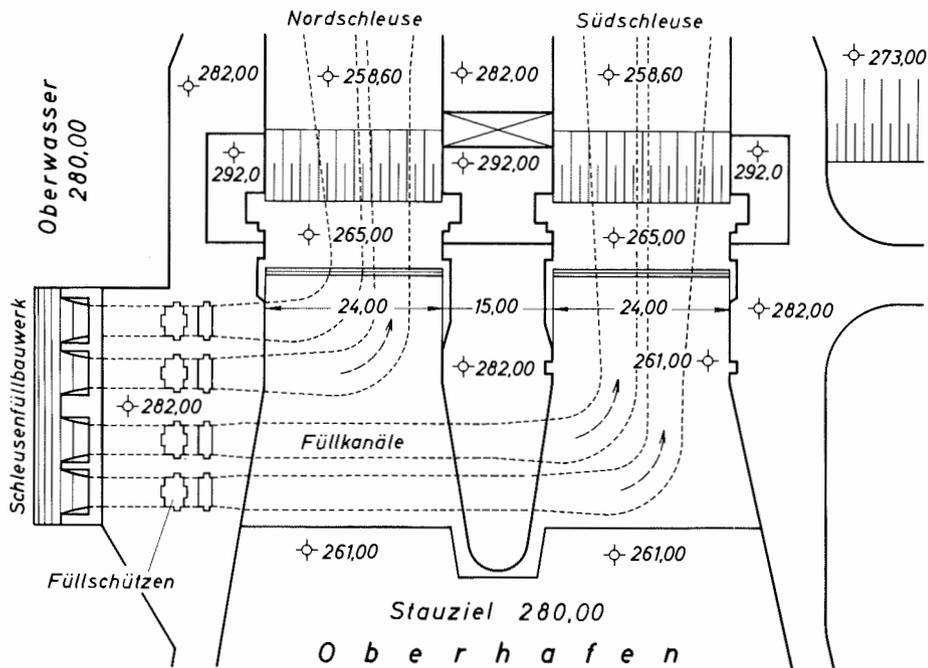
Kraftwerk Aschach: Schleusen-Oberhaupt mit Schleusenfüllbauwerk und Schleusenfüllkanälen, Grundriß
